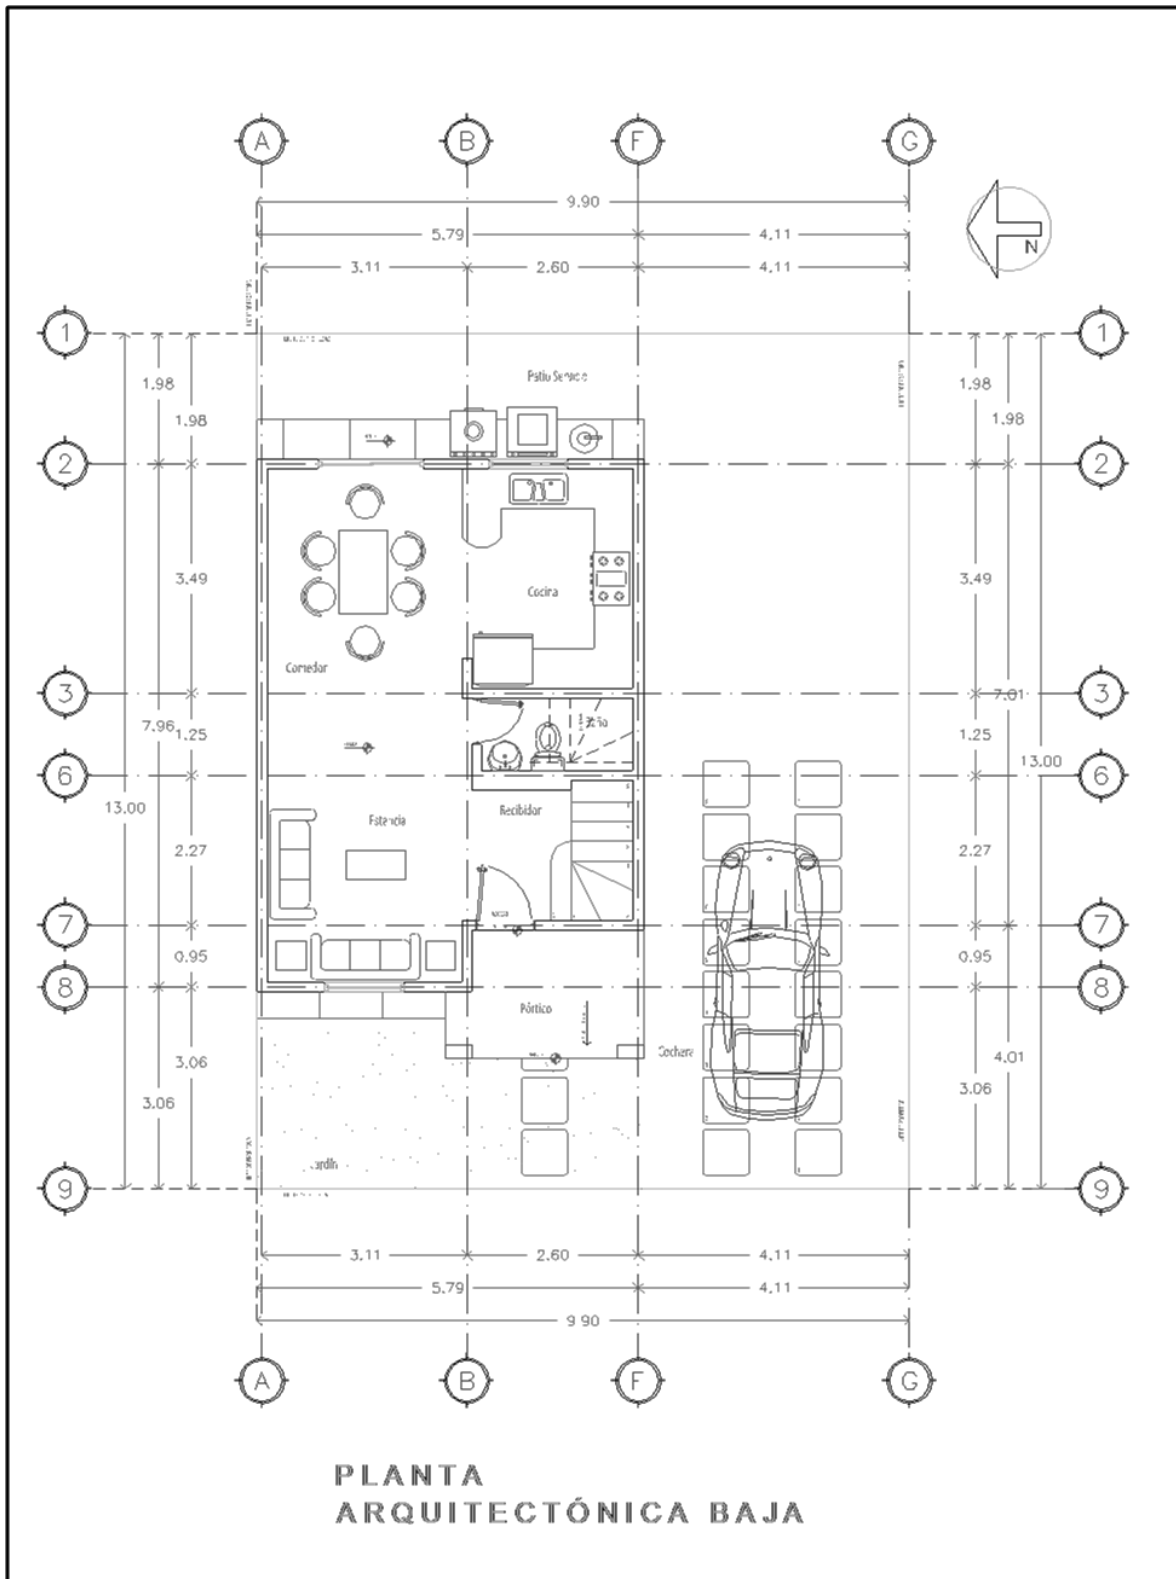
Planta arquitectónica de la vivienda a estudiar.
